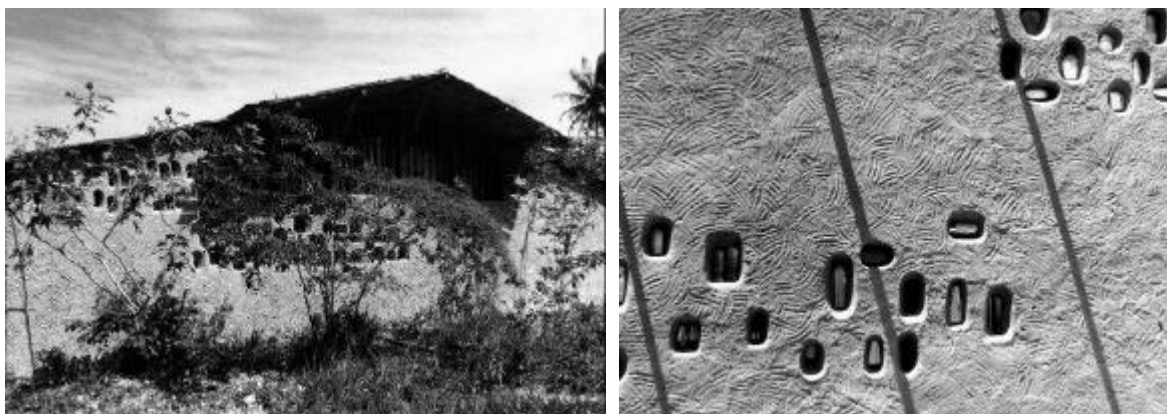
Fachada posterior(oeste) e detalhe dos vitrais de garrafas e da textura da parede de terra.
